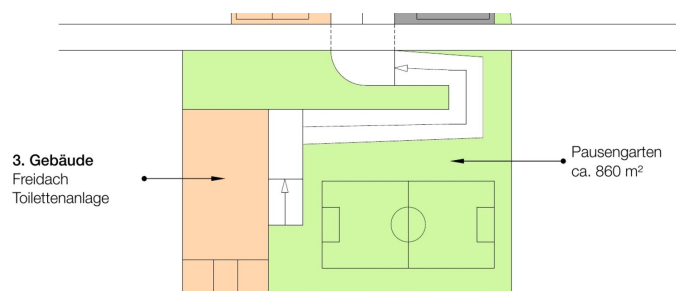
Grundriss Freigelände (April 2017)
